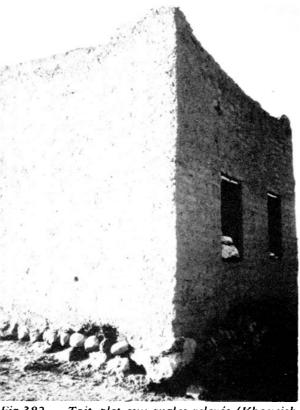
Toit plat aux angles relevés (Khoueish, Syrie).
